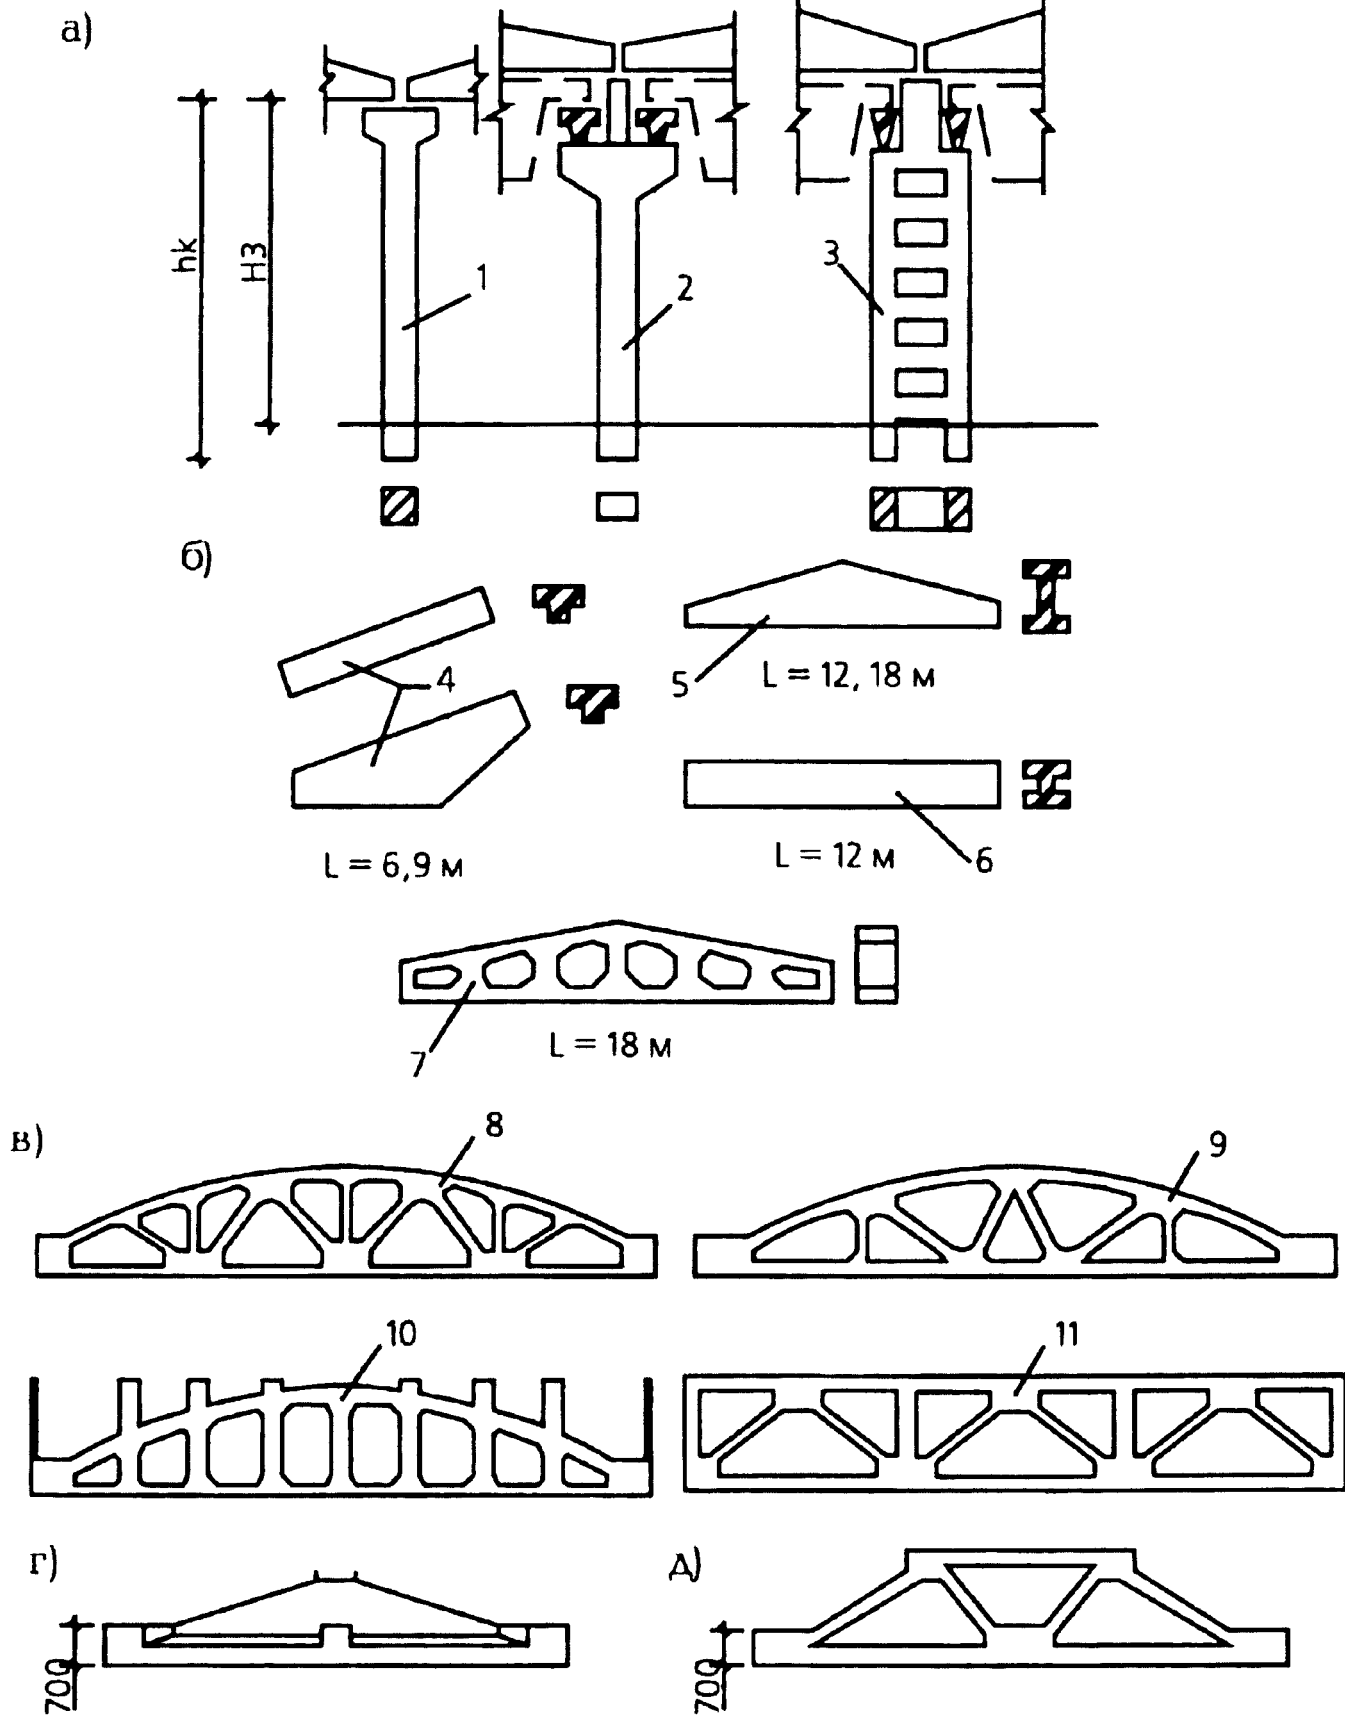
Элементы одноэтажного железобетонного каркаса промышленного здания: а - колонны; б - стропильные балки (СБ); в - стропильные фермы (СФ); г - подстропильная балка; д - подстропильная ферма; 1 - колонны в зданиях без мостовых кранов; 2, 3 - колонны в зданиях с мостовыми кранами; 4 - односкатные СБ ($L = 6,9$ м); 5 - двускатная СБ ($L = 12, 18$ м); 6 - СБ с параллельными поясами ($L = 12$ м); 7 - решетчатая СБ ($L = 18$ м); 8 - сегментная СФ; 9 - арочная раскосная СФ; 10 - арочная безраскосная СФ; 11 - СФ с параллельными поясами
